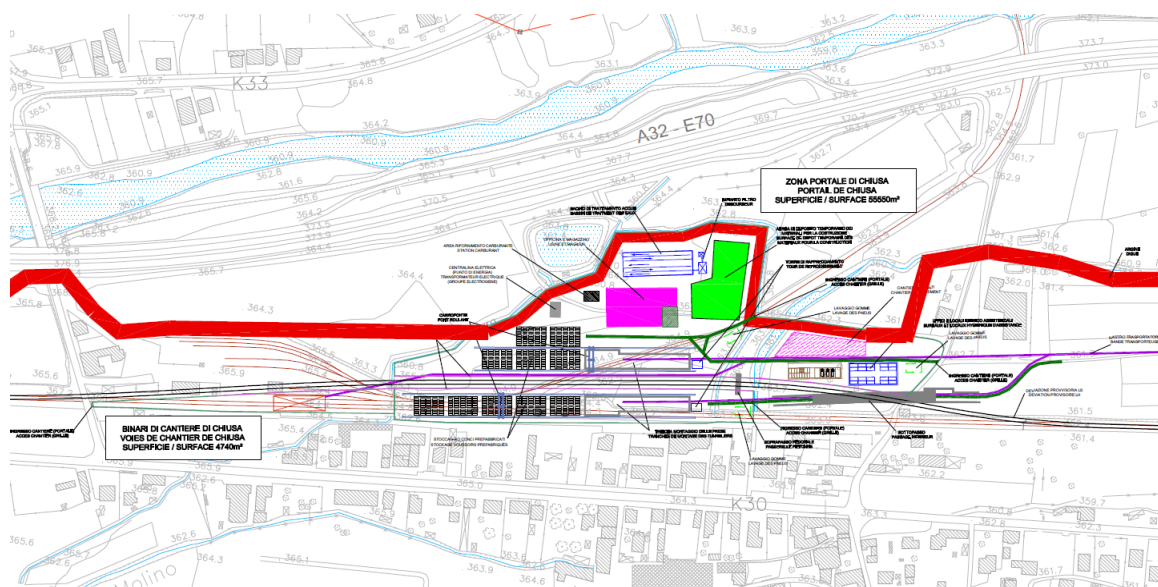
Vista del cantiere dell'imbocco Est del tunnel dell'Orsiera
